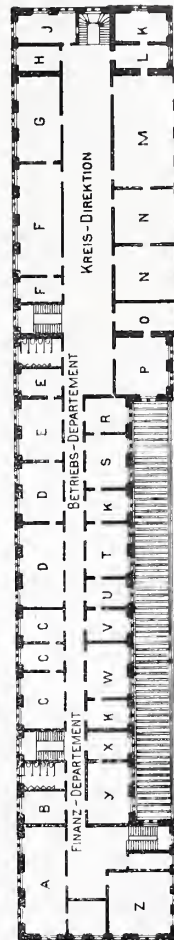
Grundriss vom I. Stock des Verwaltungsgebäudes. — Masstab 1:1000.
